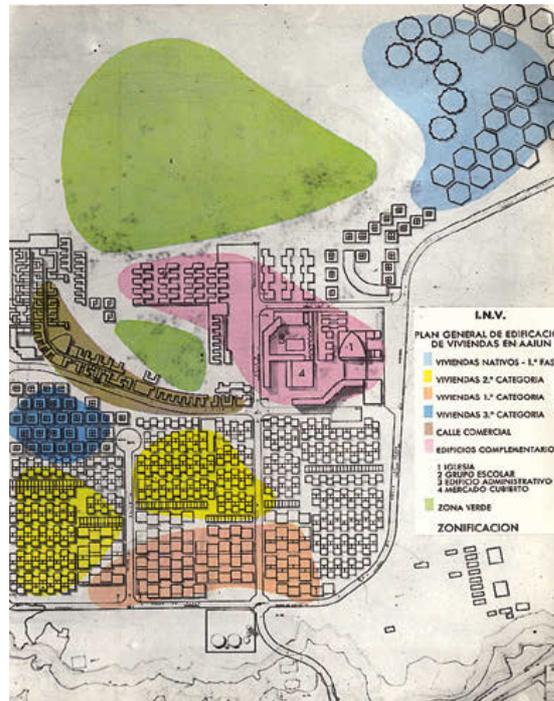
/ Planta de nuevo barrio en El Aaiún. Ramón Estalella, con la colaboración de José Serrano-Suñer y Juan Pedro Capote (1962)
